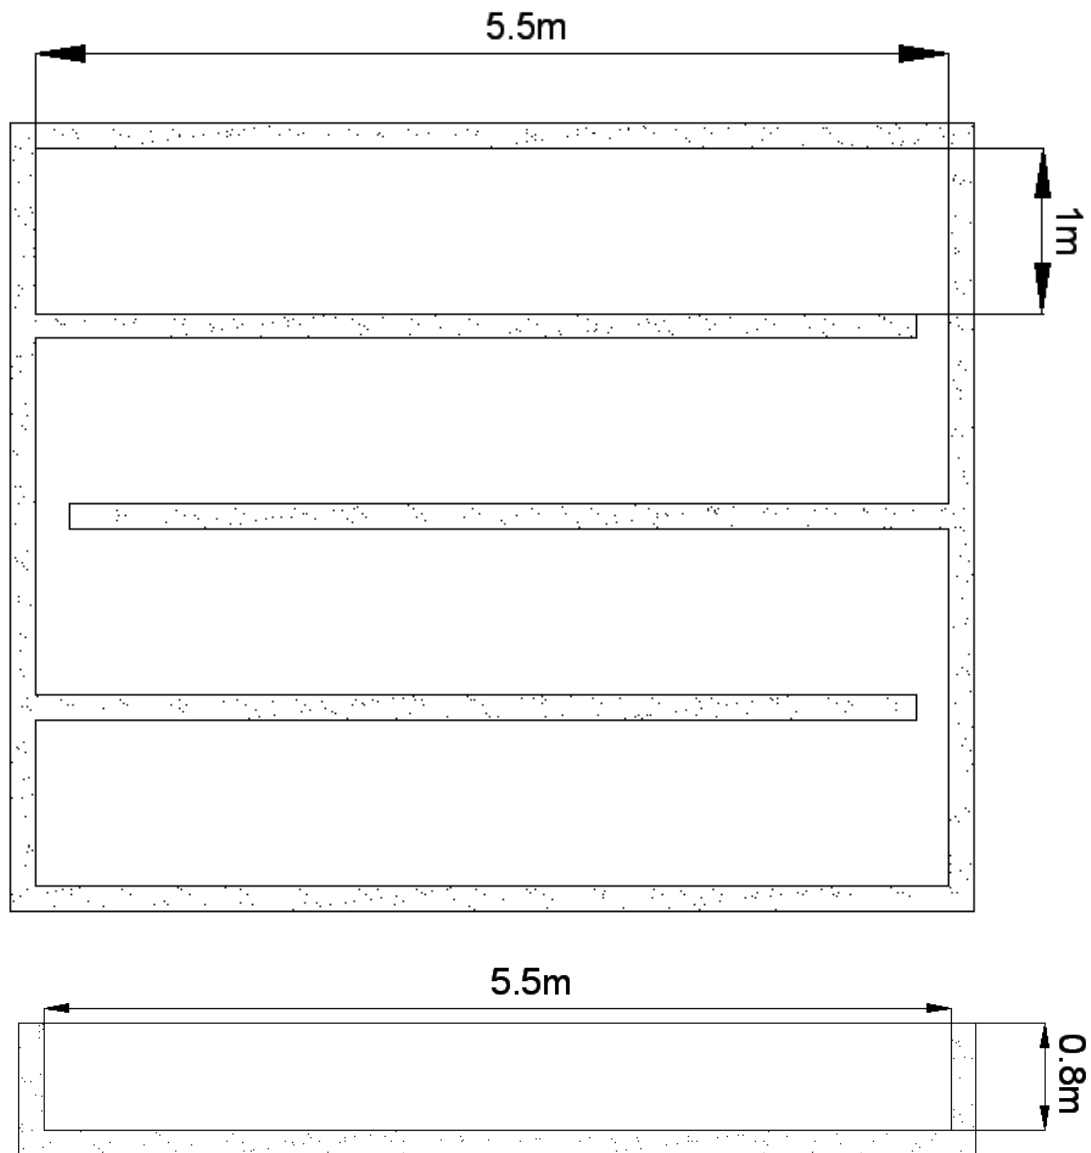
vista en planta y perfil del tanque de contacto con el cloro.
